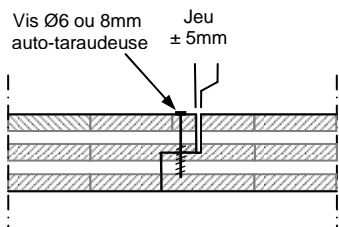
jonctions courantes entre panneaux de plancher ou de murs
